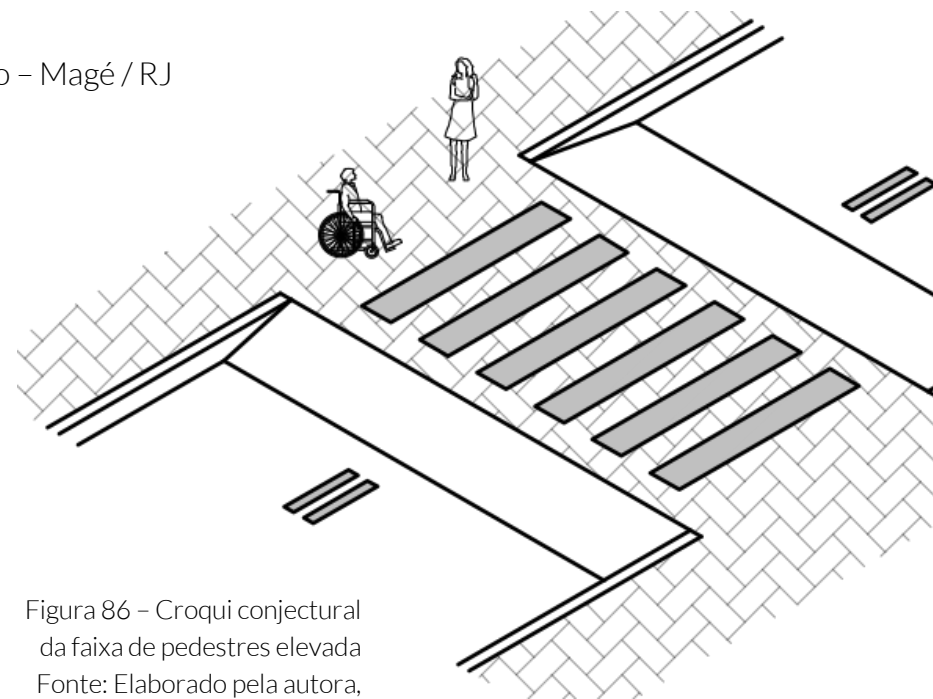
Croqui conjectural da faixa de pedestres elevada
